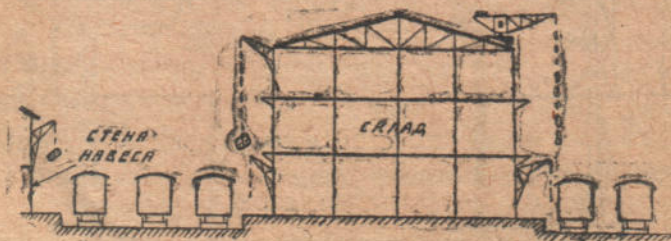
Кровельные и стенные краны на внутренних погрузочных фронтах в порту.
